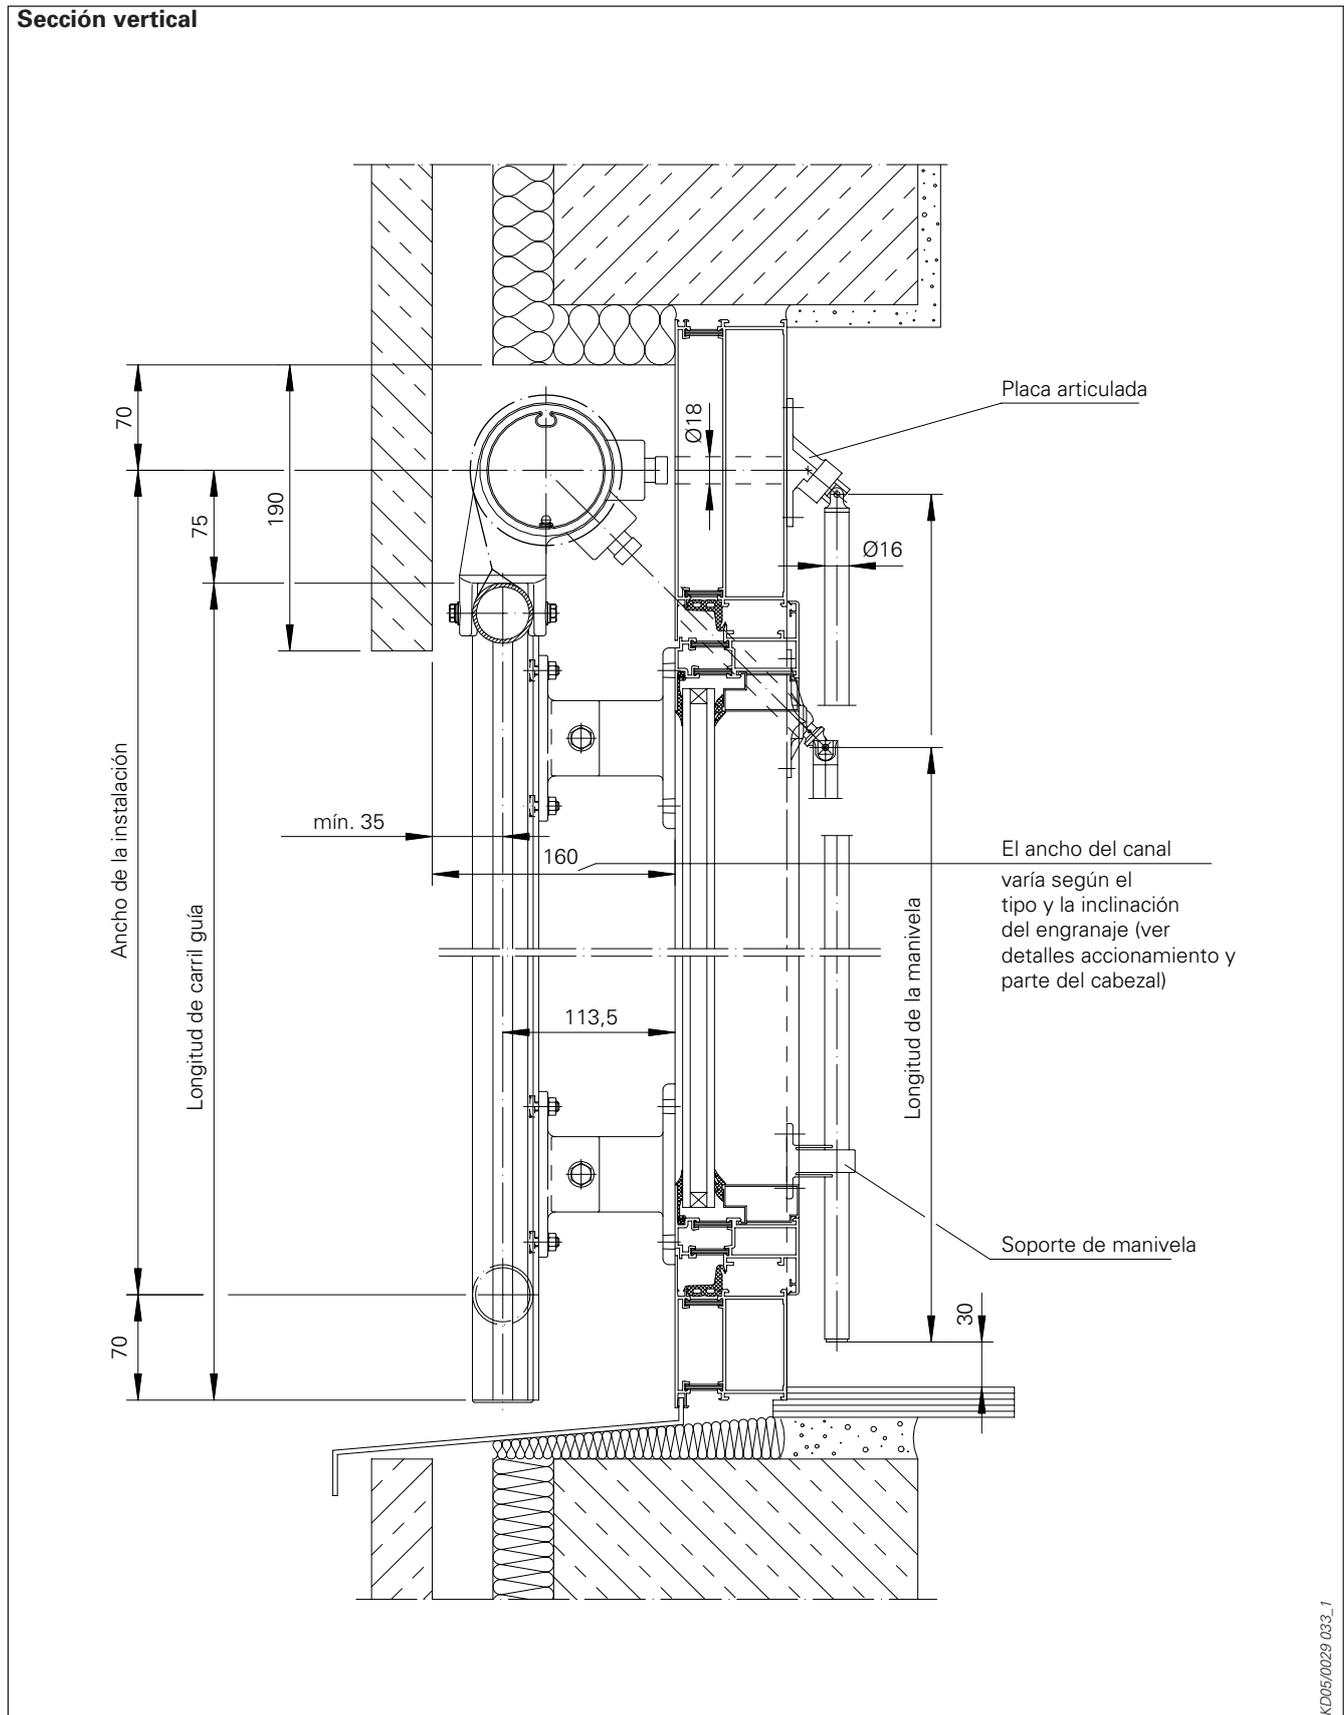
Sección vertical toldo para fachadas modelo 201 K en canal in situ, enrollamiento a la derecha
